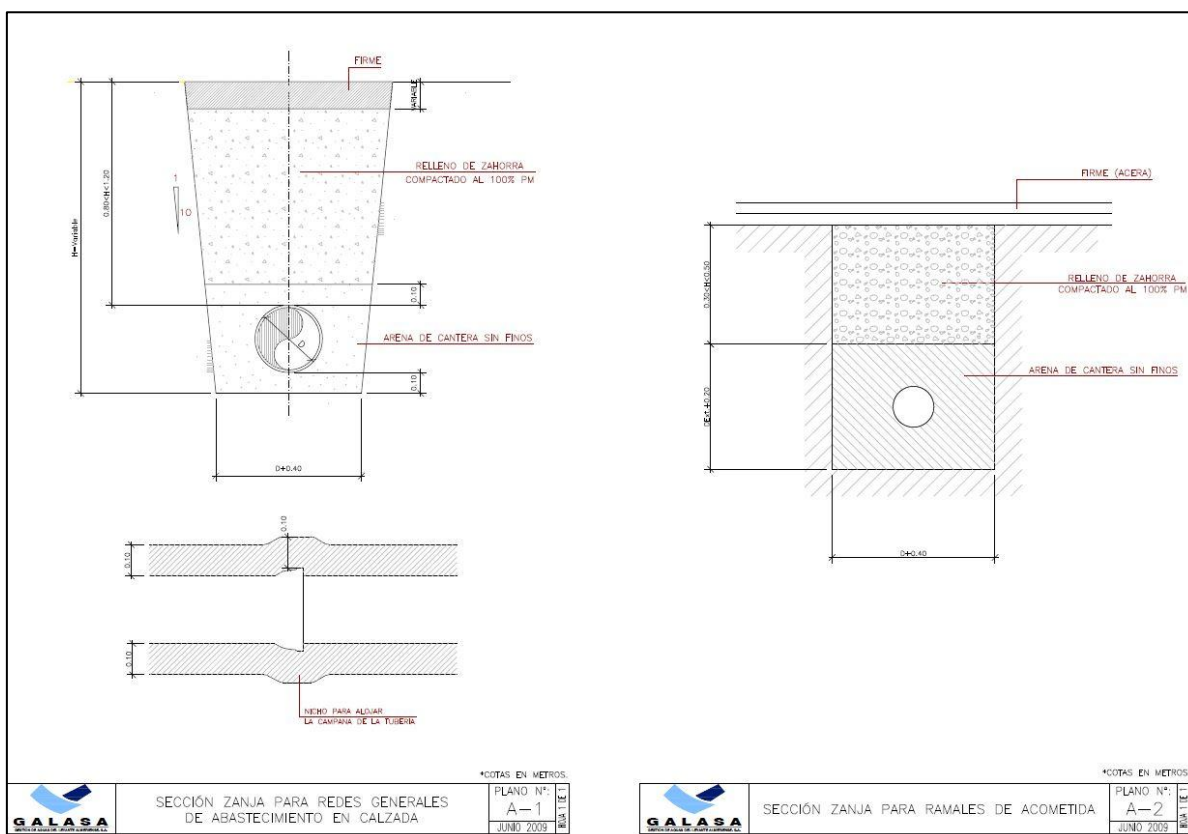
Detalles Constructivos. Especificaciones técnicas constructivas de acuerdo a GALASA. Ejecución de zanjas. Fuente: Galasa.
